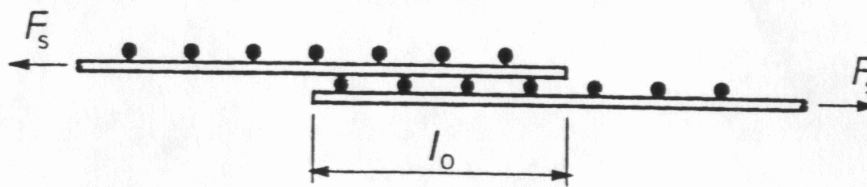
Поперечне армування для з'єднань внапуск
